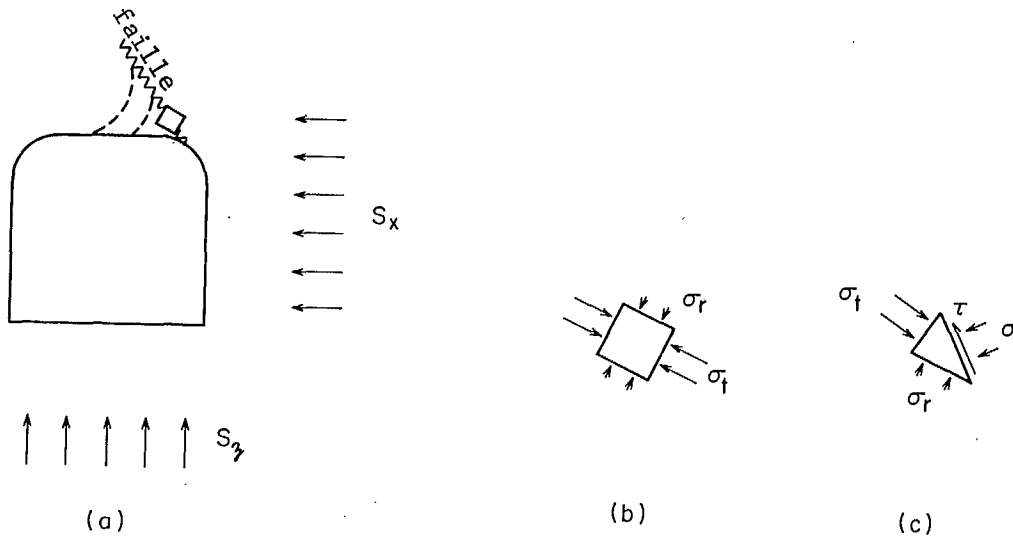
Les conséquences de l'intersection d'une faille et du plafond d'une excavation.
